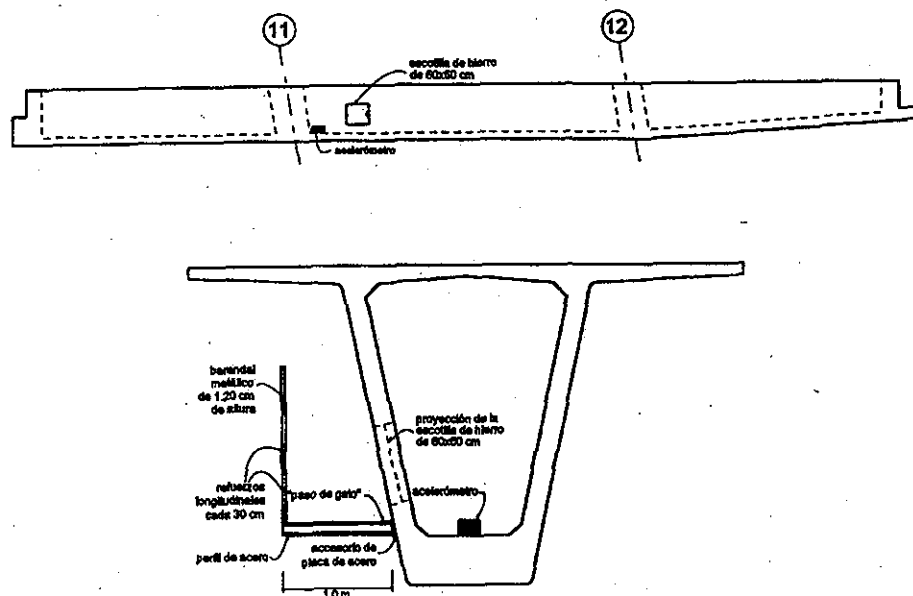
Sección transversal de la trabe de apoyo TA-16 instrumentada y acelerómetros instalados (Aguilar y Alcocer, 1997)
